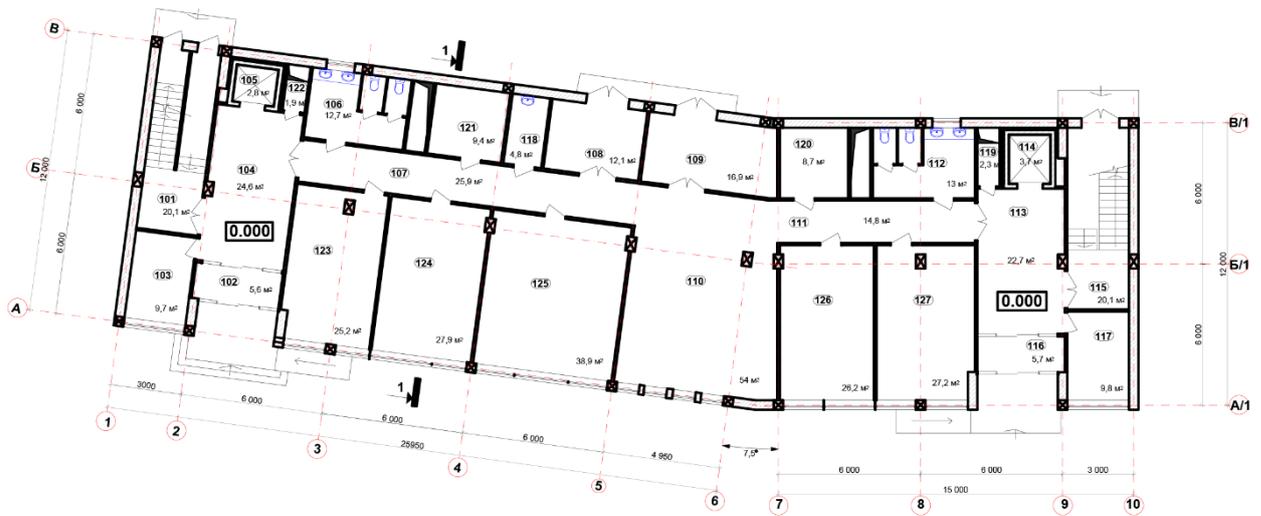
План 3-го этажа планируемого к размещению делового центра
